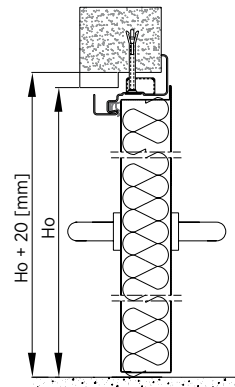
Montage mural d'un bloc-porte à deux battants avec bâti angulaire - coupe verticale
